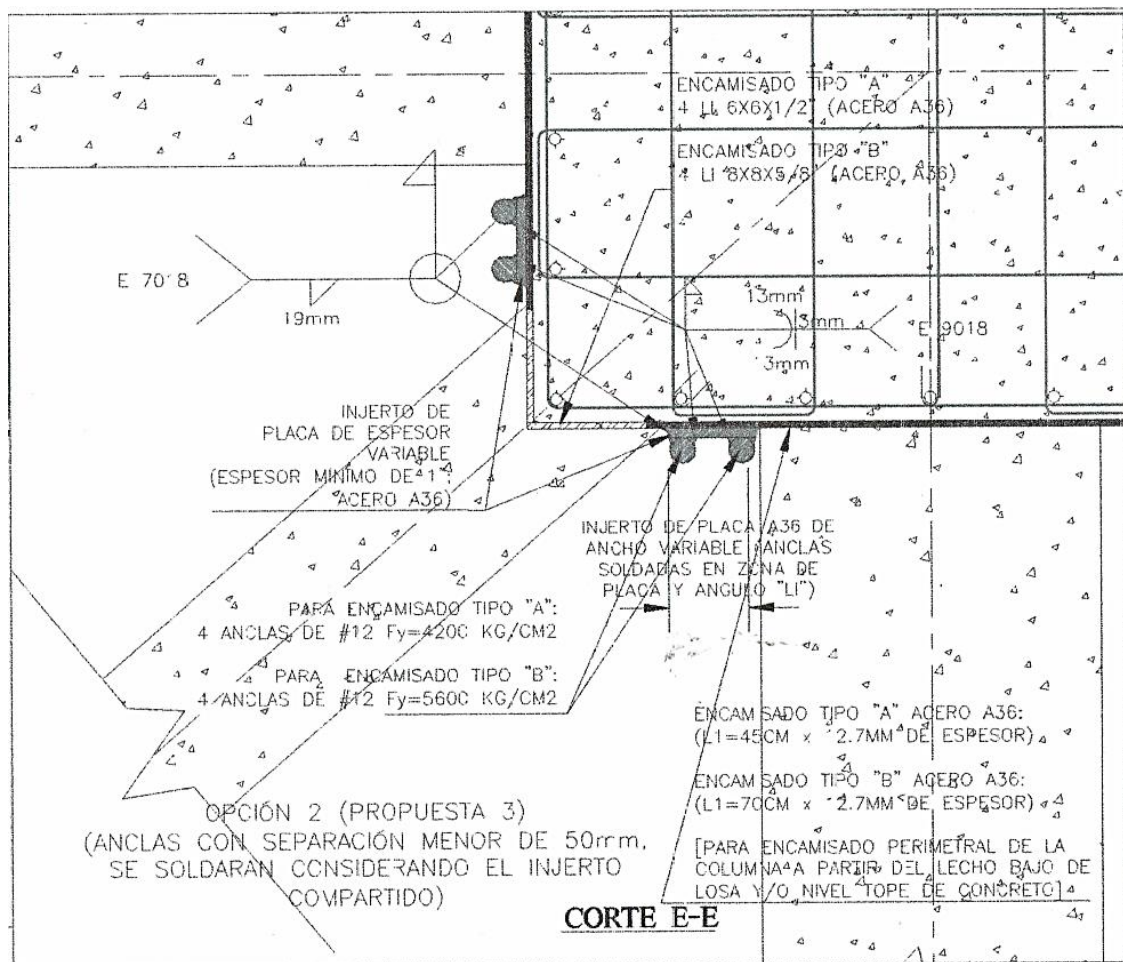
Características del sistema de refuerzo con barras atravesadas en el sistema de piso, tomado de los planos estructurales de Gómez González (2020).
